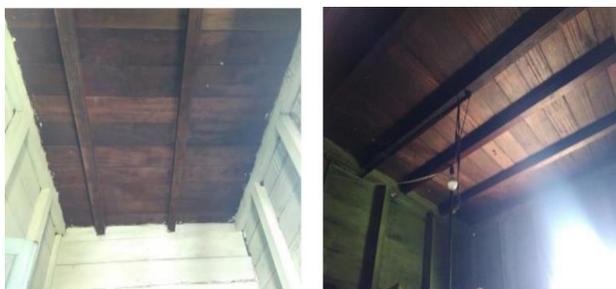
Detail konstruksi lantai dan dinding bangunan
